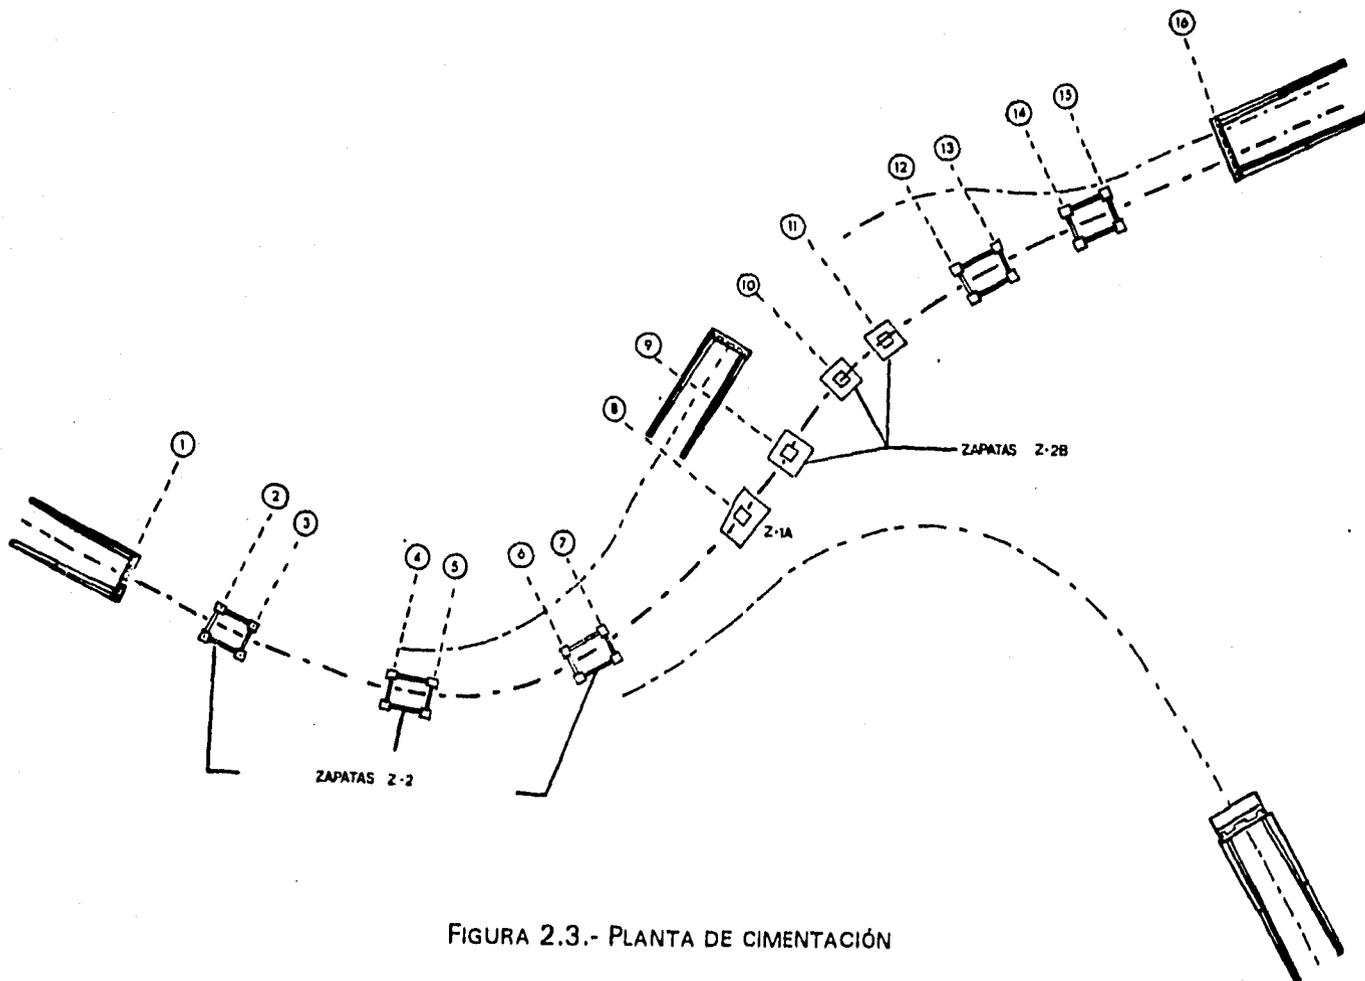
PLANTA DE CIMENTACIÓN
